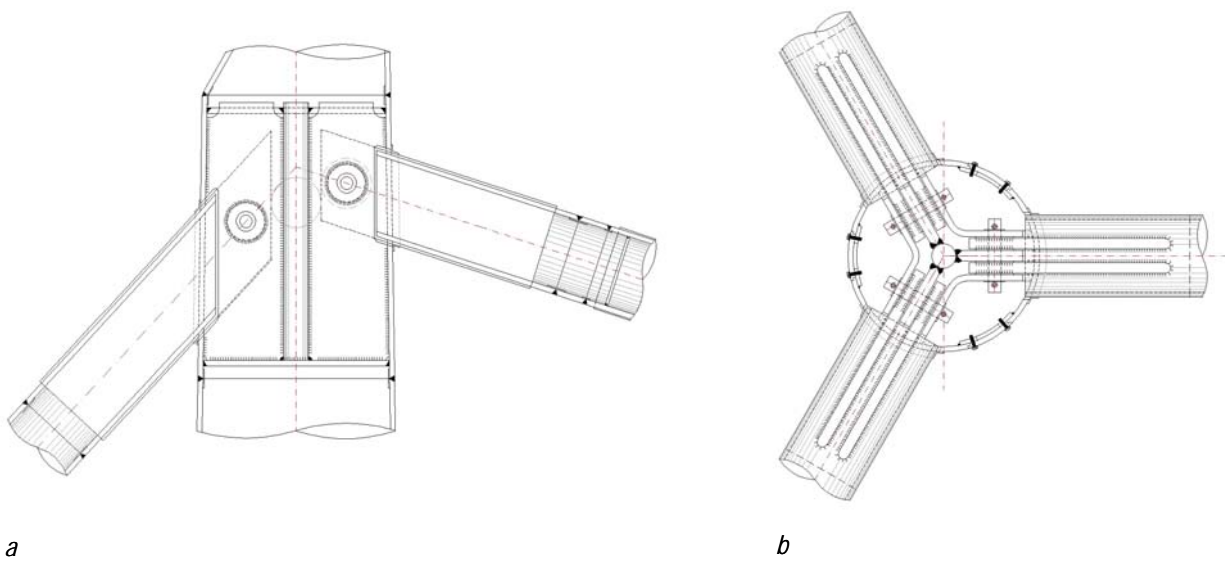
Unión de los cordones superiores al pilono; a) Sección longitudinal; b) Sección transversal
